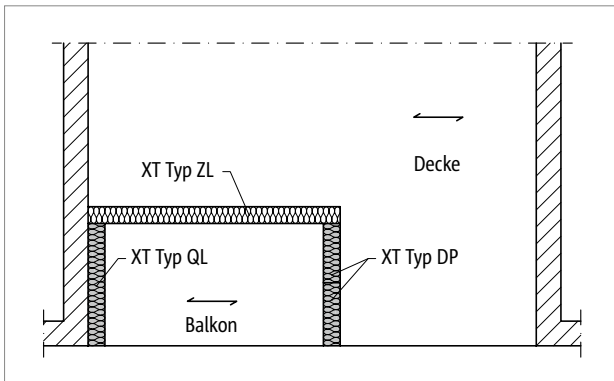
Schöck Isokorb® XT Typ DP, QL: Decke einachsig gespannt
